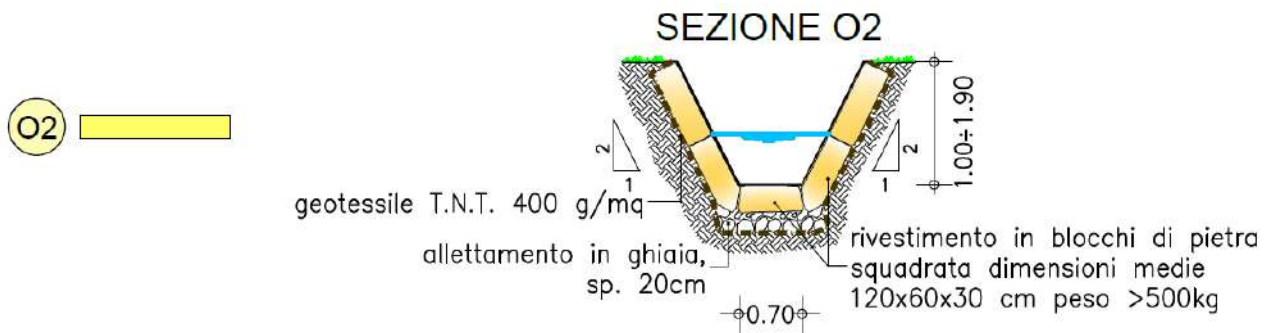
sezione tipo fosso Ovest. Estratto elaborato T-05.
